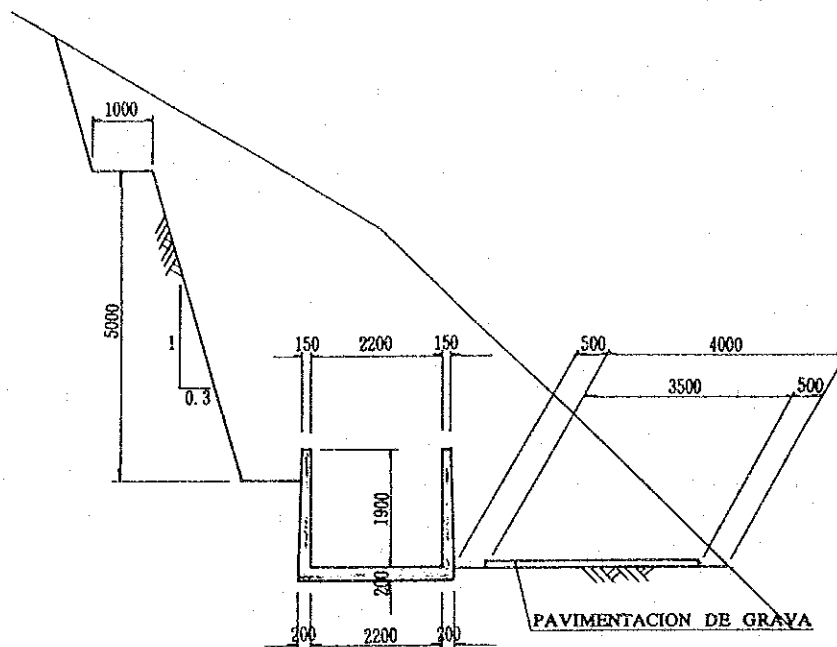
Sección Típica de Canal Abierto (Canal de conducción)
